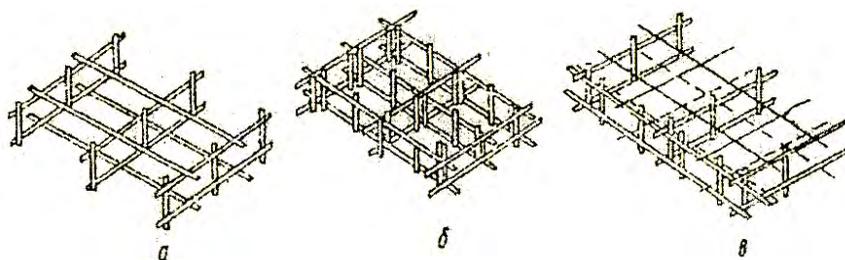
Примеры конструкций пространственных каркасов для армирования плоских железобетонных элементов:
